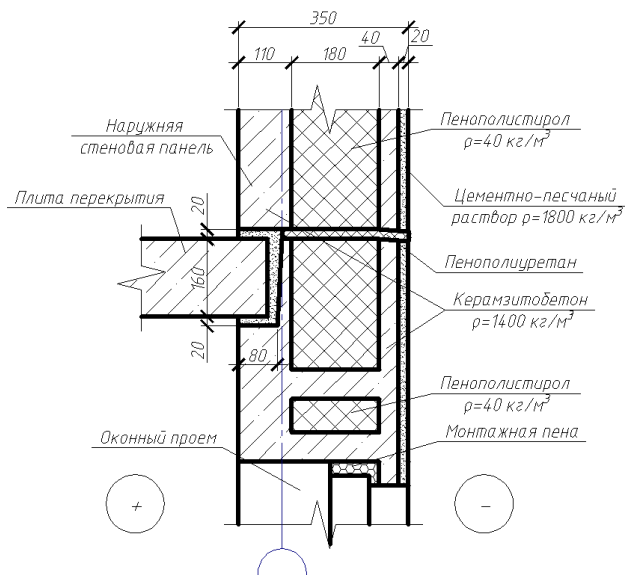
Узел примыкания наружного ограждения к внутренней железобетонной стене и плите перекрытия. Предлагаемое решение.
